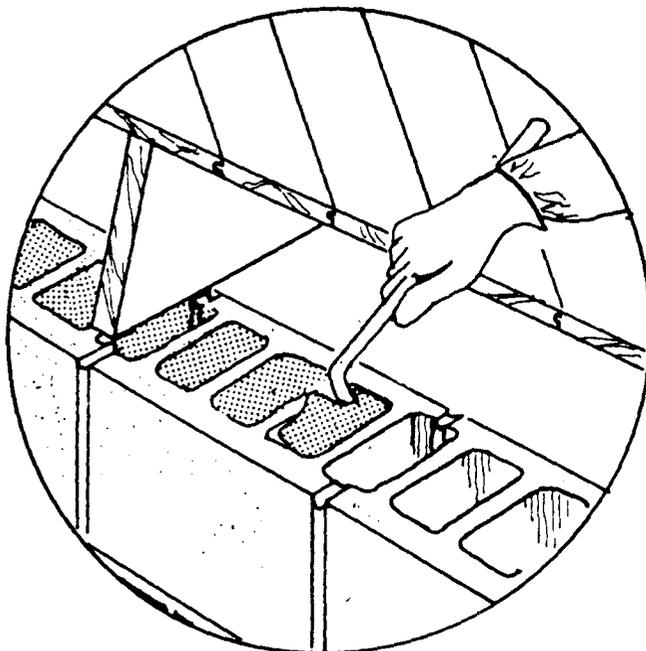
(B) ENLÈVEMENT DE LA MIUF DES CREUX DES BLOCS DE FONDATION
